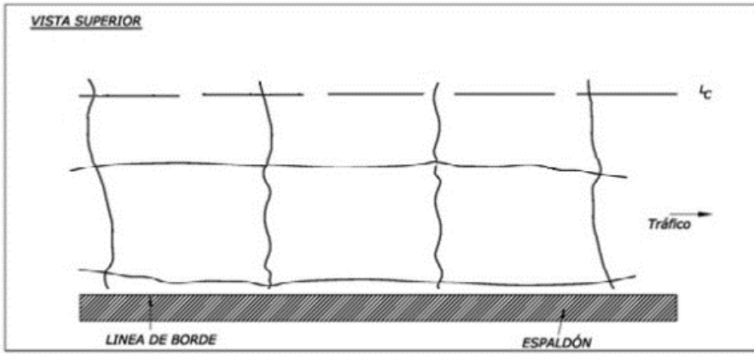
Agrietamiento por Reflejo de Juntas – Pavimento Flexible
